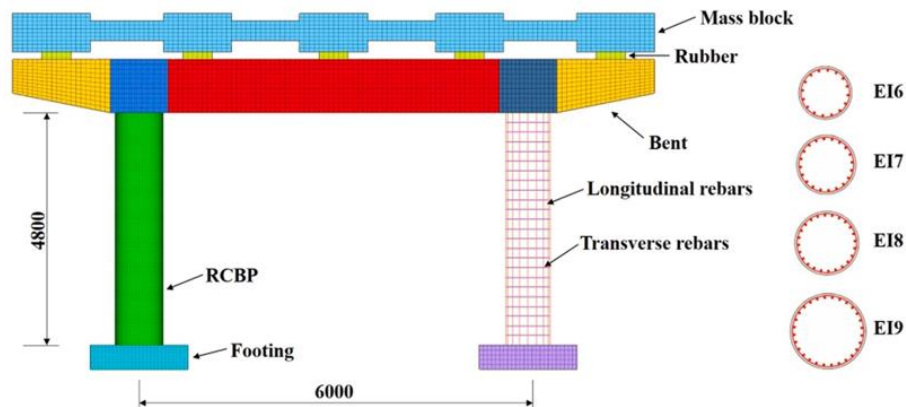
Geometría y refuerzo empleado en las pilas en la modelación matemática.
